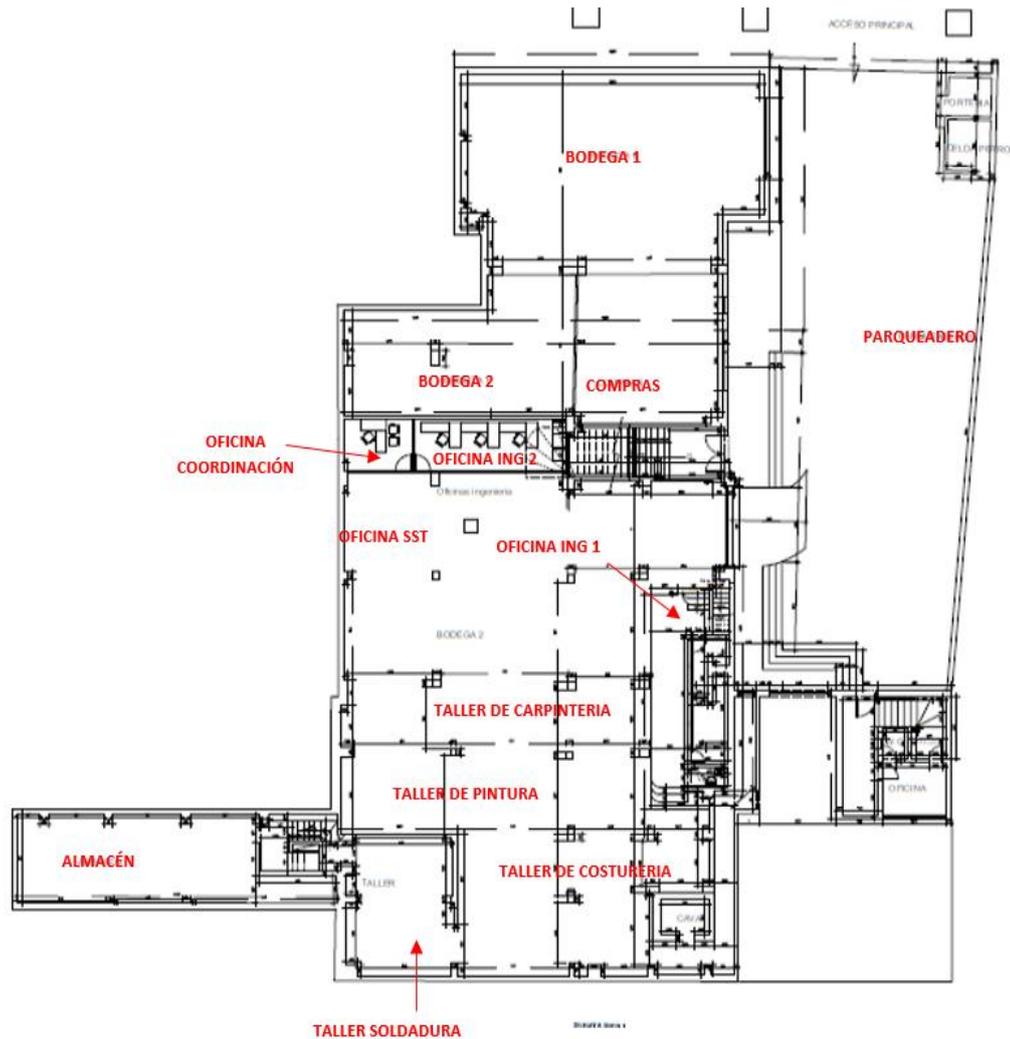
Plano de planta 1 del área de infraestructura y mantenimiento del Hospital.
